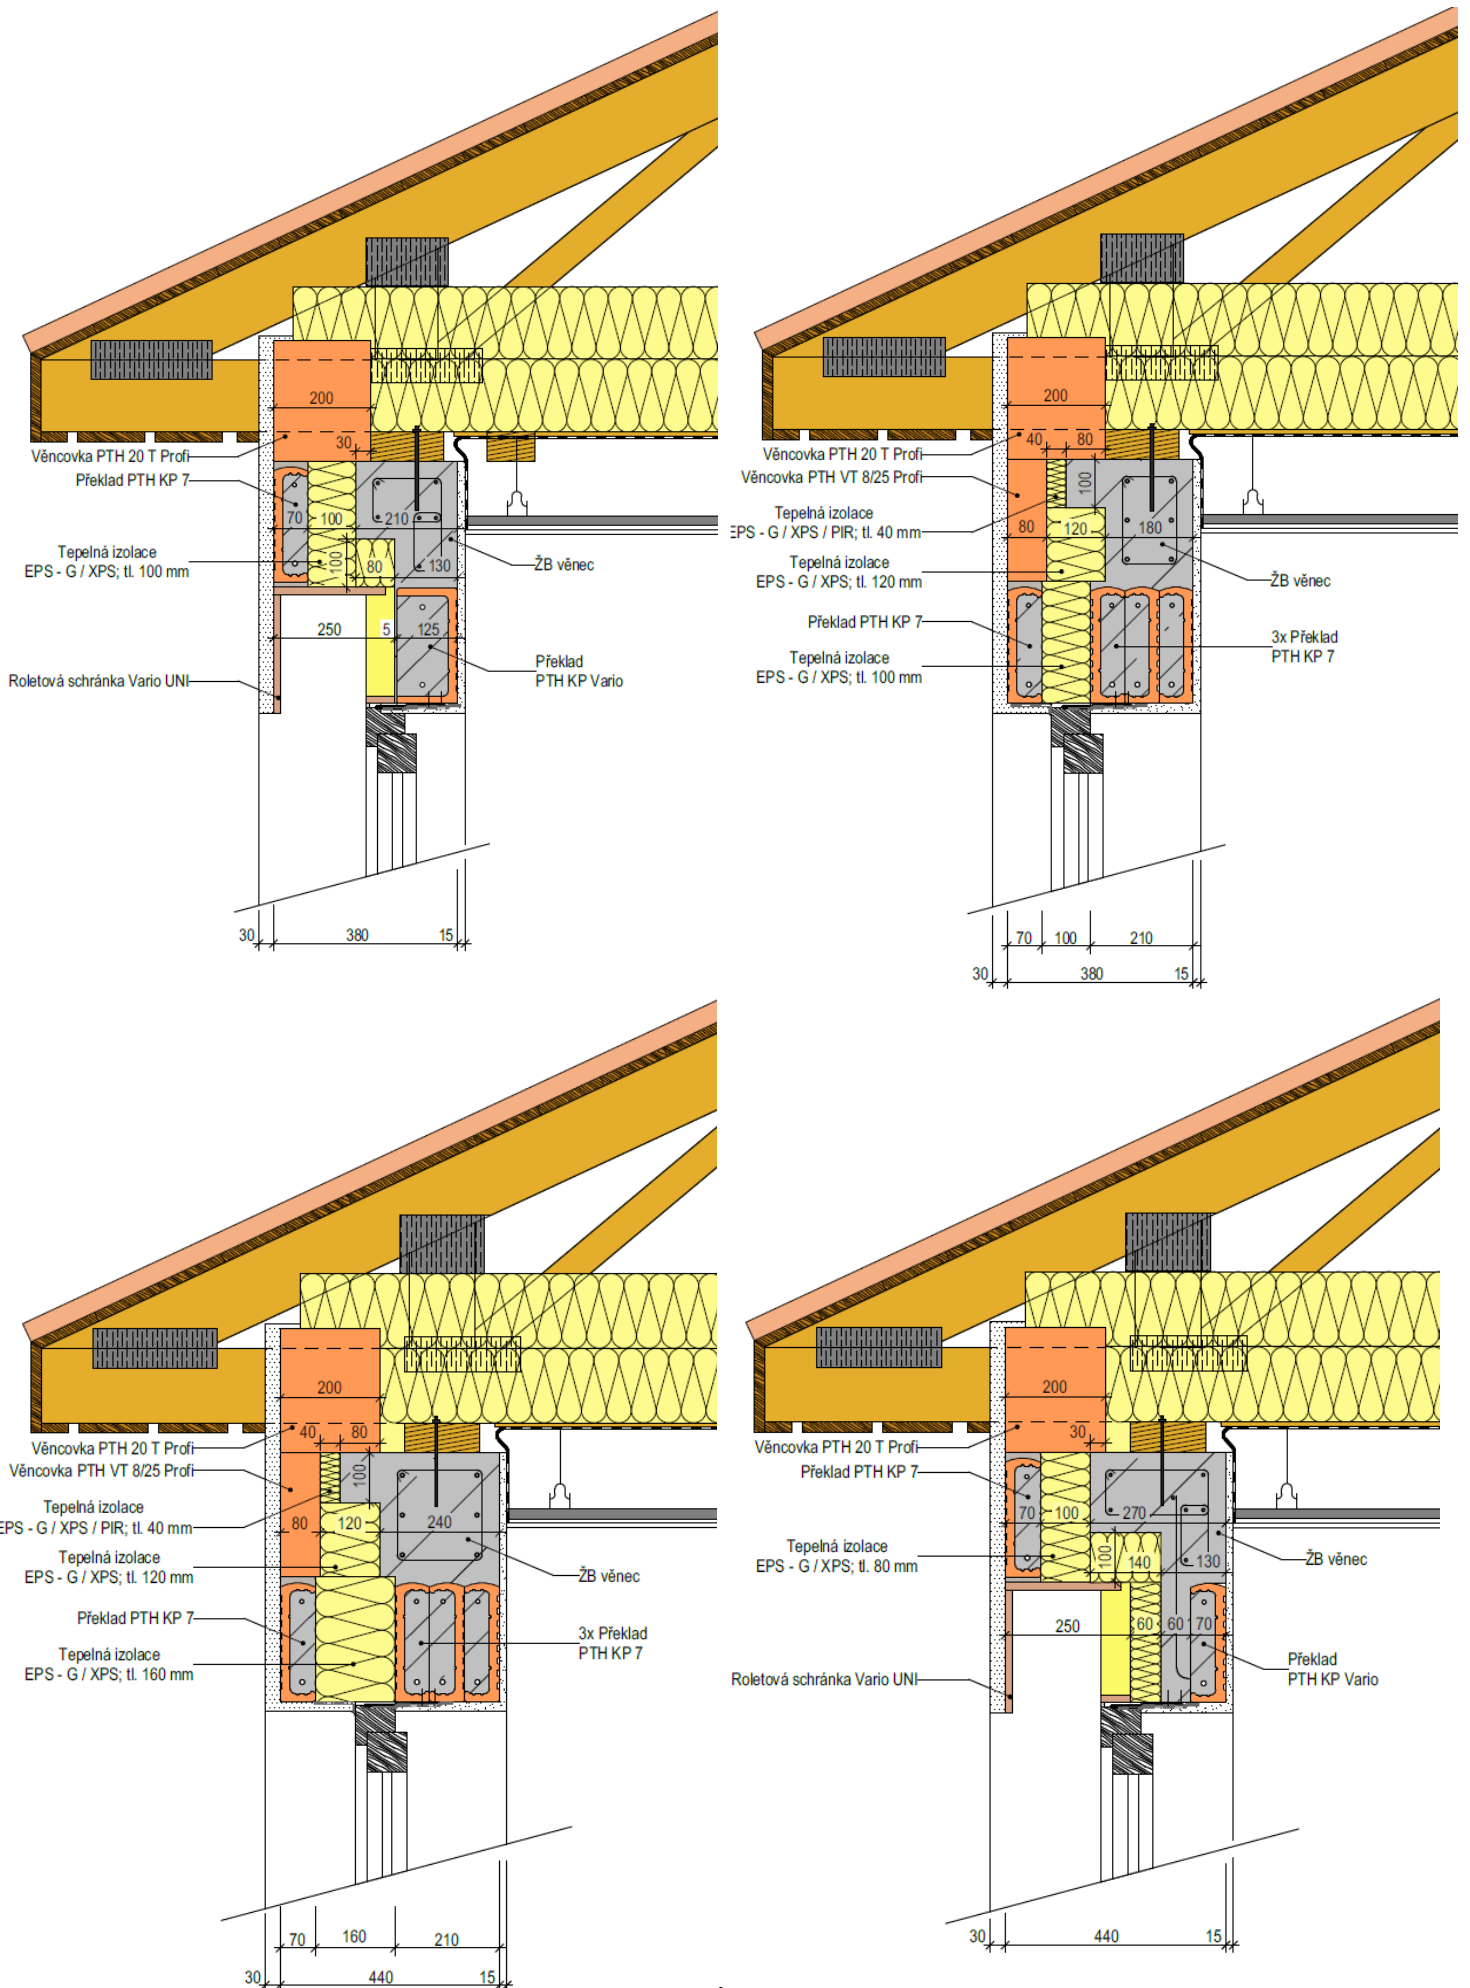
porovnání stropních konstrukcí v BIM ArchiCAD
